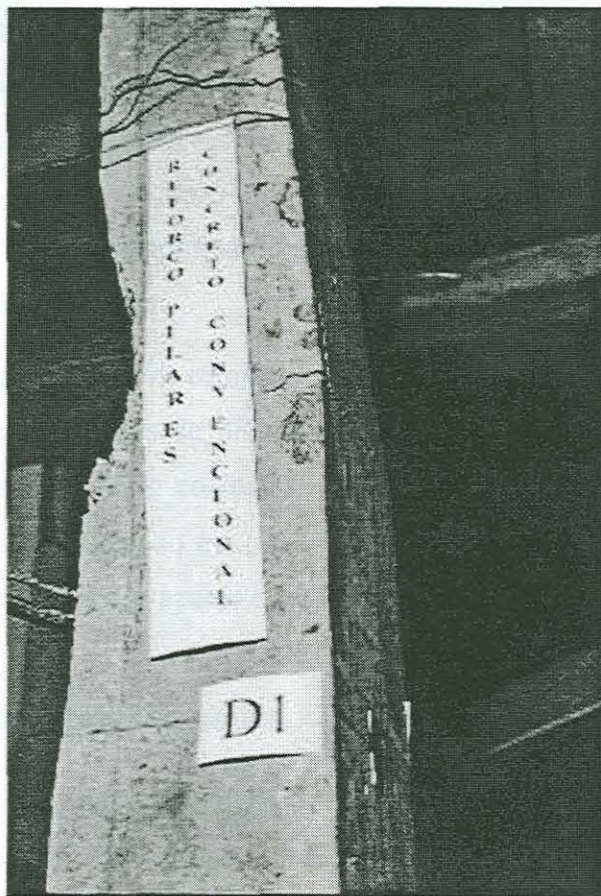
Pilar reforçado com concreto armado em 3 faces, esmagamento do concreto.
